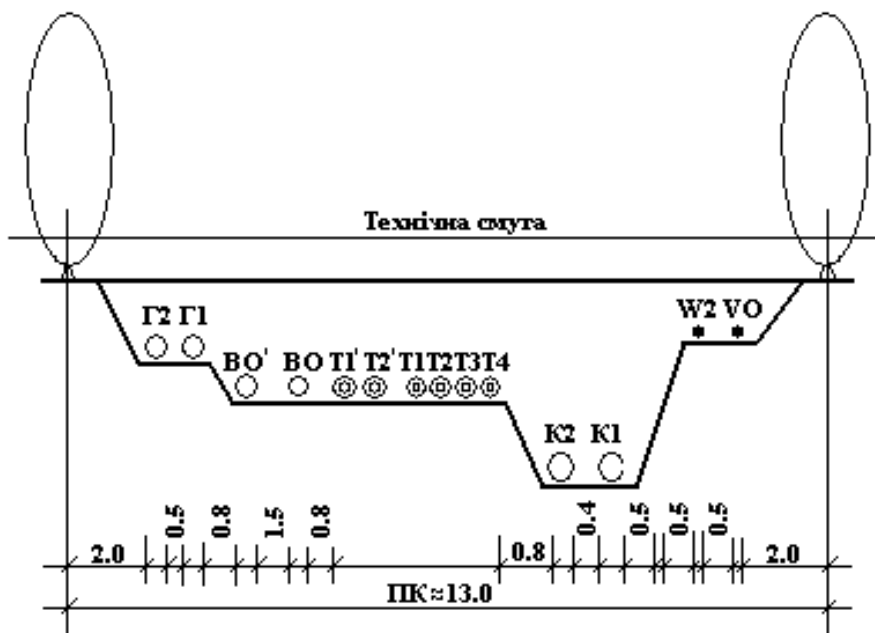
Поперечний переріз траншеї з трубопроводами
